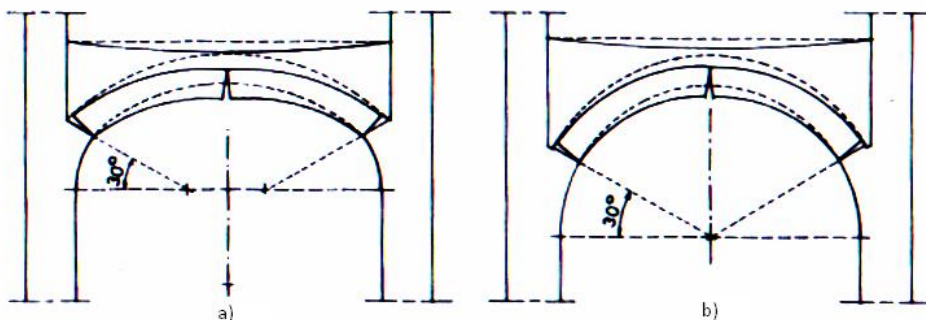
Fissuração tipo em arcos e abóbadas sujeitos a cargas verticais: a) rebaixadas; b) semicirculares.
